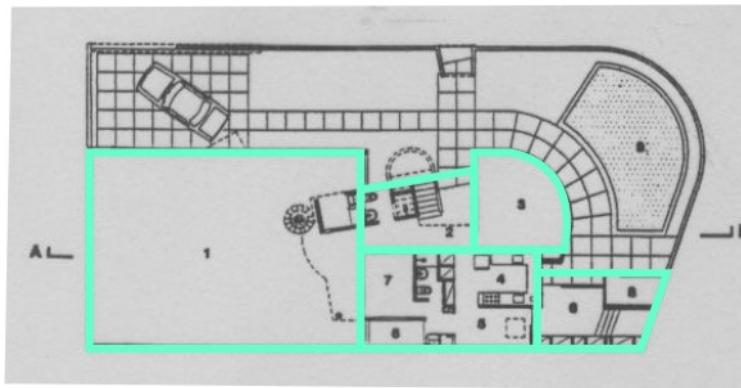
Planta do Primeiro Piso – Unidade e Conjunto
